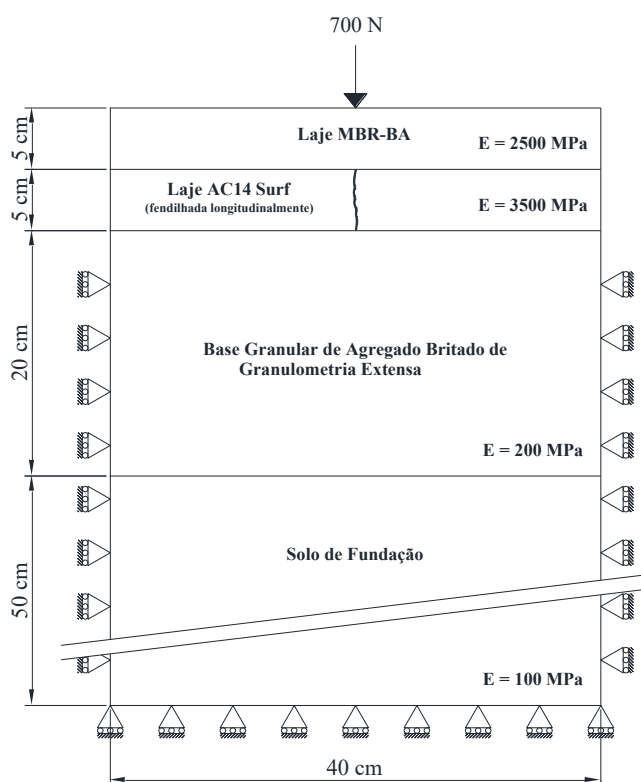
Suporte das lajes modeladas (solo fundação e ABGE)
